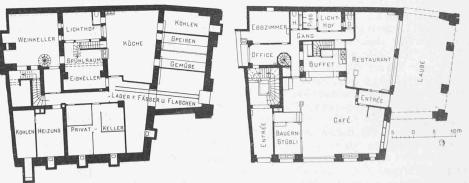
Grundriss vom Erdgeschoss. Abb. 2. Grundriss vom Kellergeschoss. I:400.
